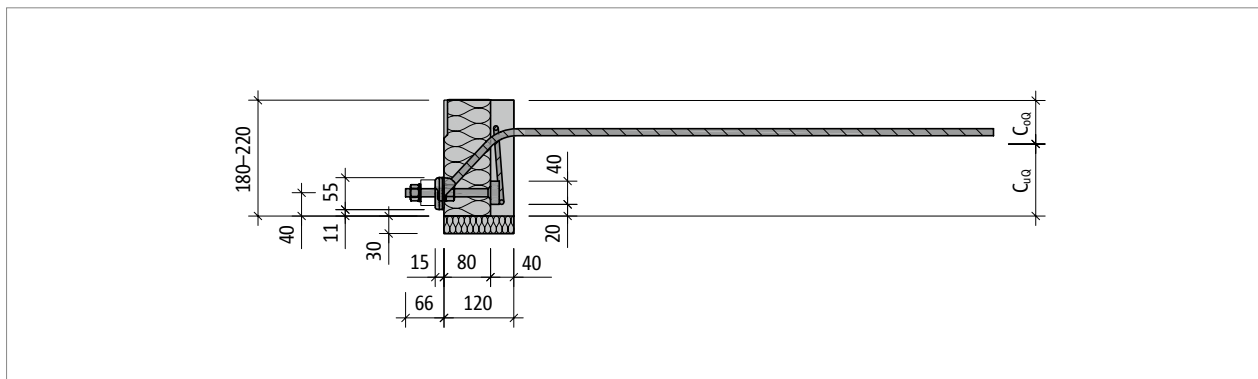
Schöck Isokorb® RT type SQ-V2: Zijaanzicht vanaf de onderzijde
